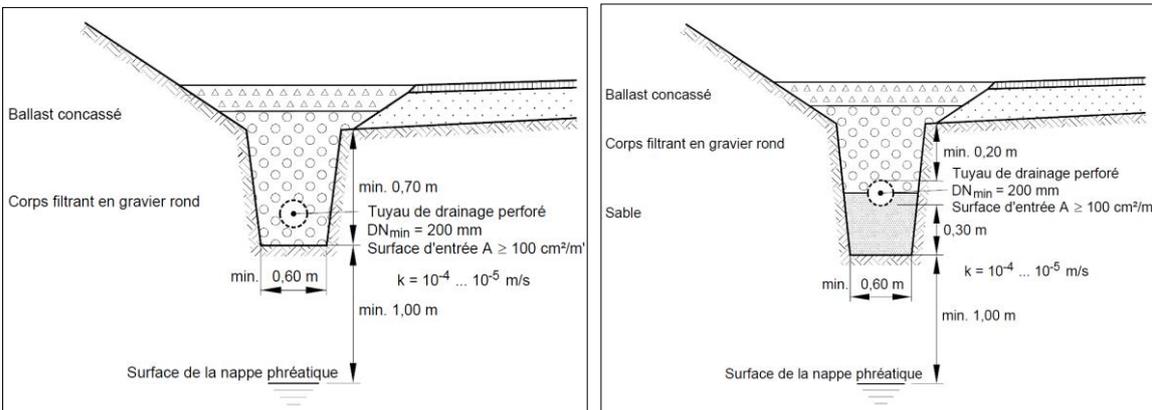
Type 3b – Tranchée drainante avec drain perforé (avec ballast ou ballast/sable)
